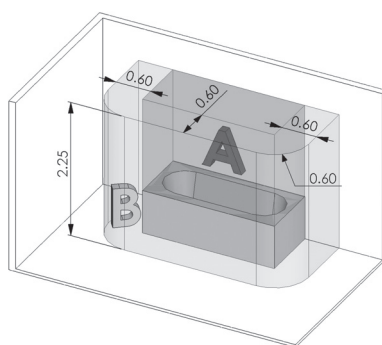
Zona de instalación / A : Volumen estructura / B : Volumen de protección
